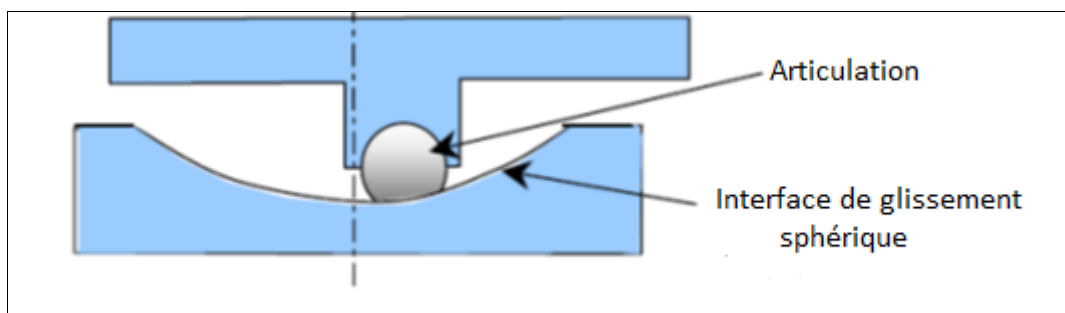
Construction typique d'un système d'isolation par glissement FPI
